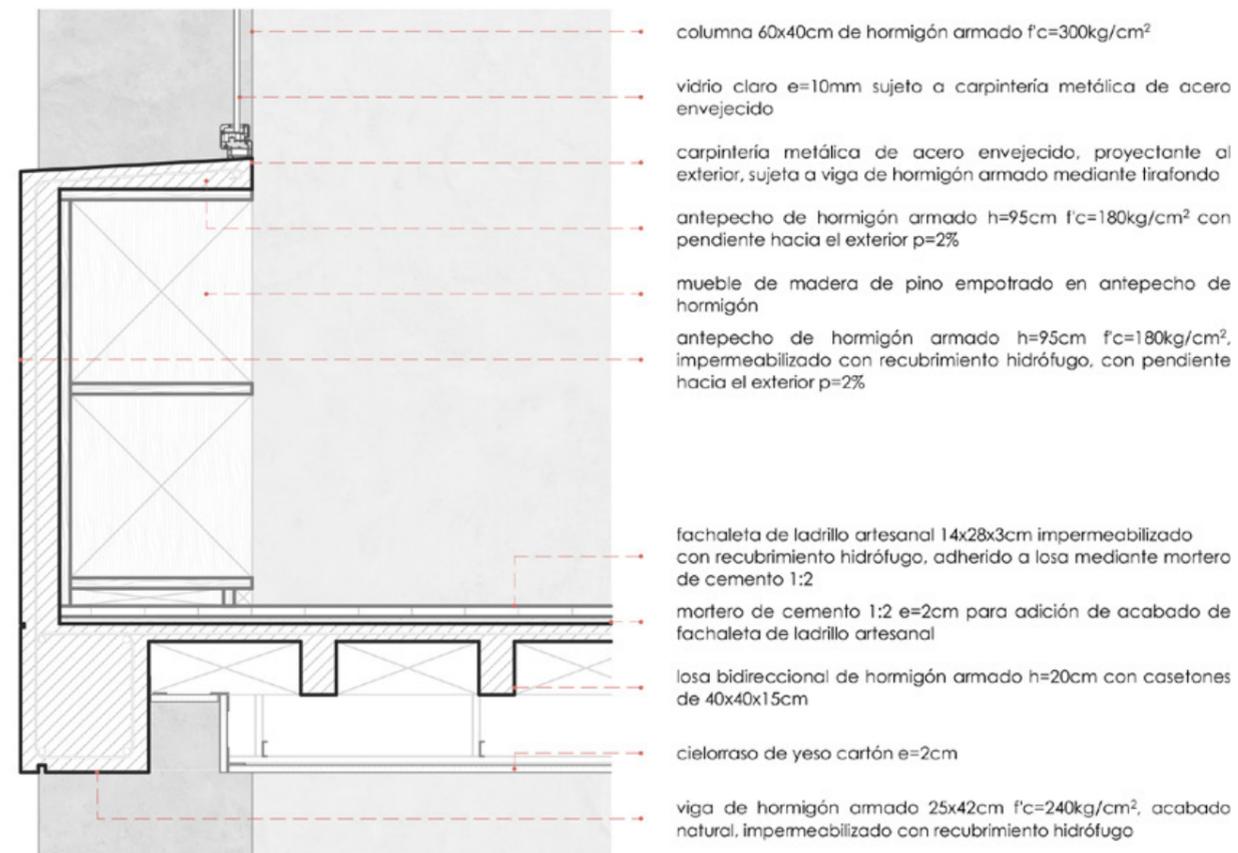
Detalle constructivo 2. Fuente: Elaboración propia.
